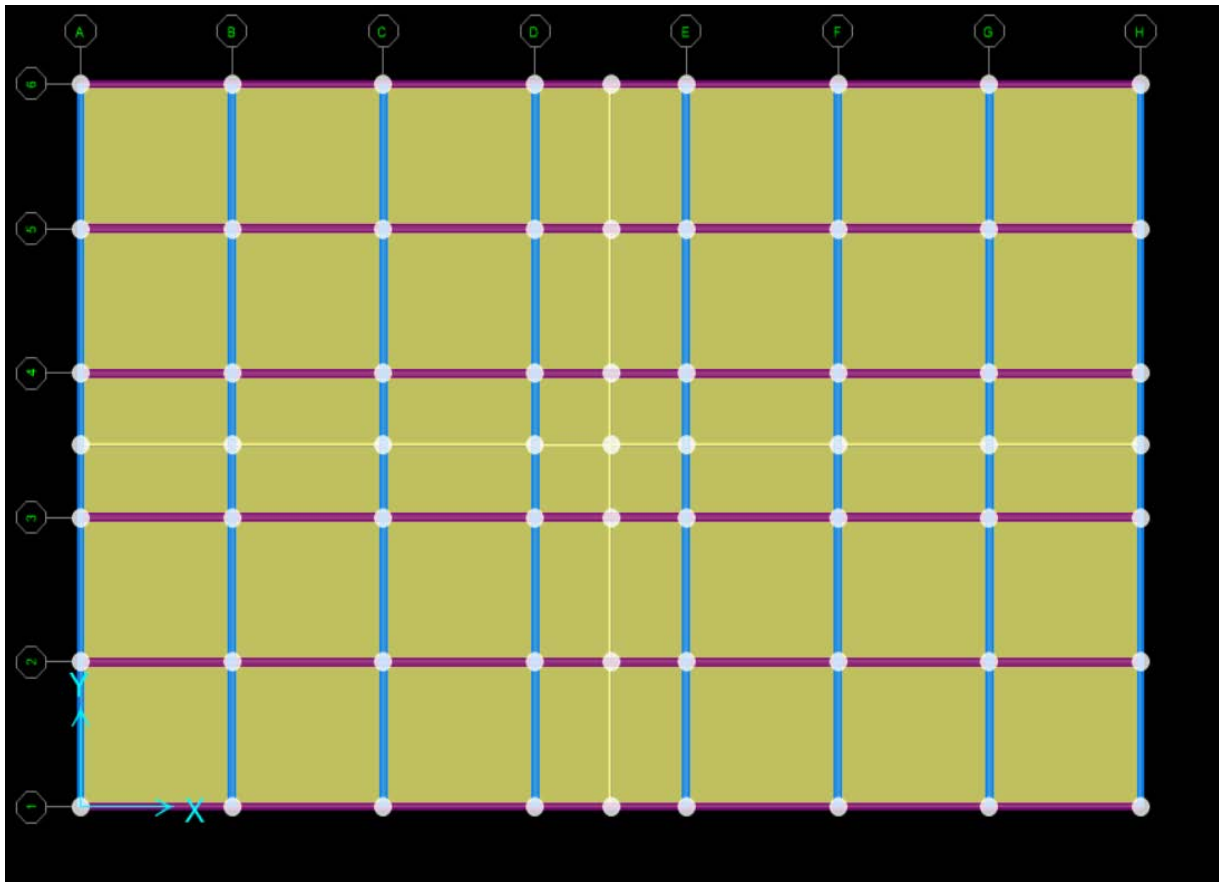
Distribución en planta de edificios del sistema de muros y dual
